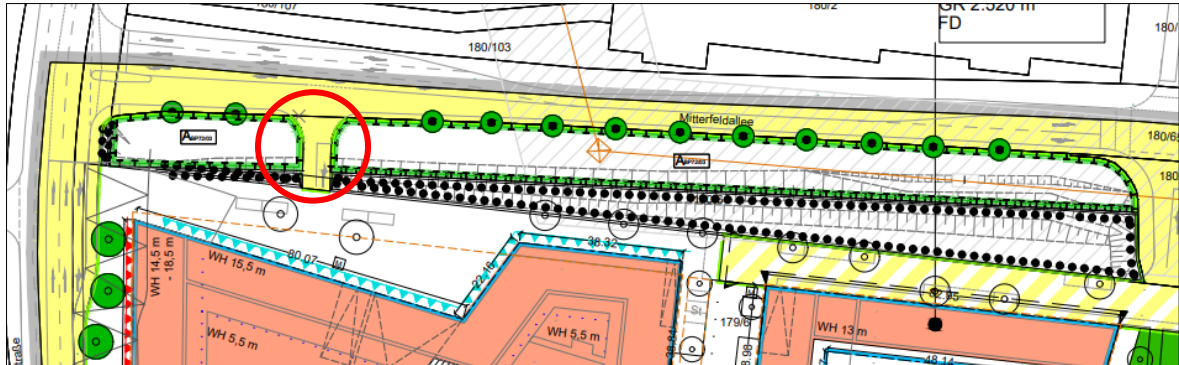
Lage der Ausgleichsfläche $A_{BP73/03}$ sowie Darstellung der geplanten Zufahrt (maßstabslos)
